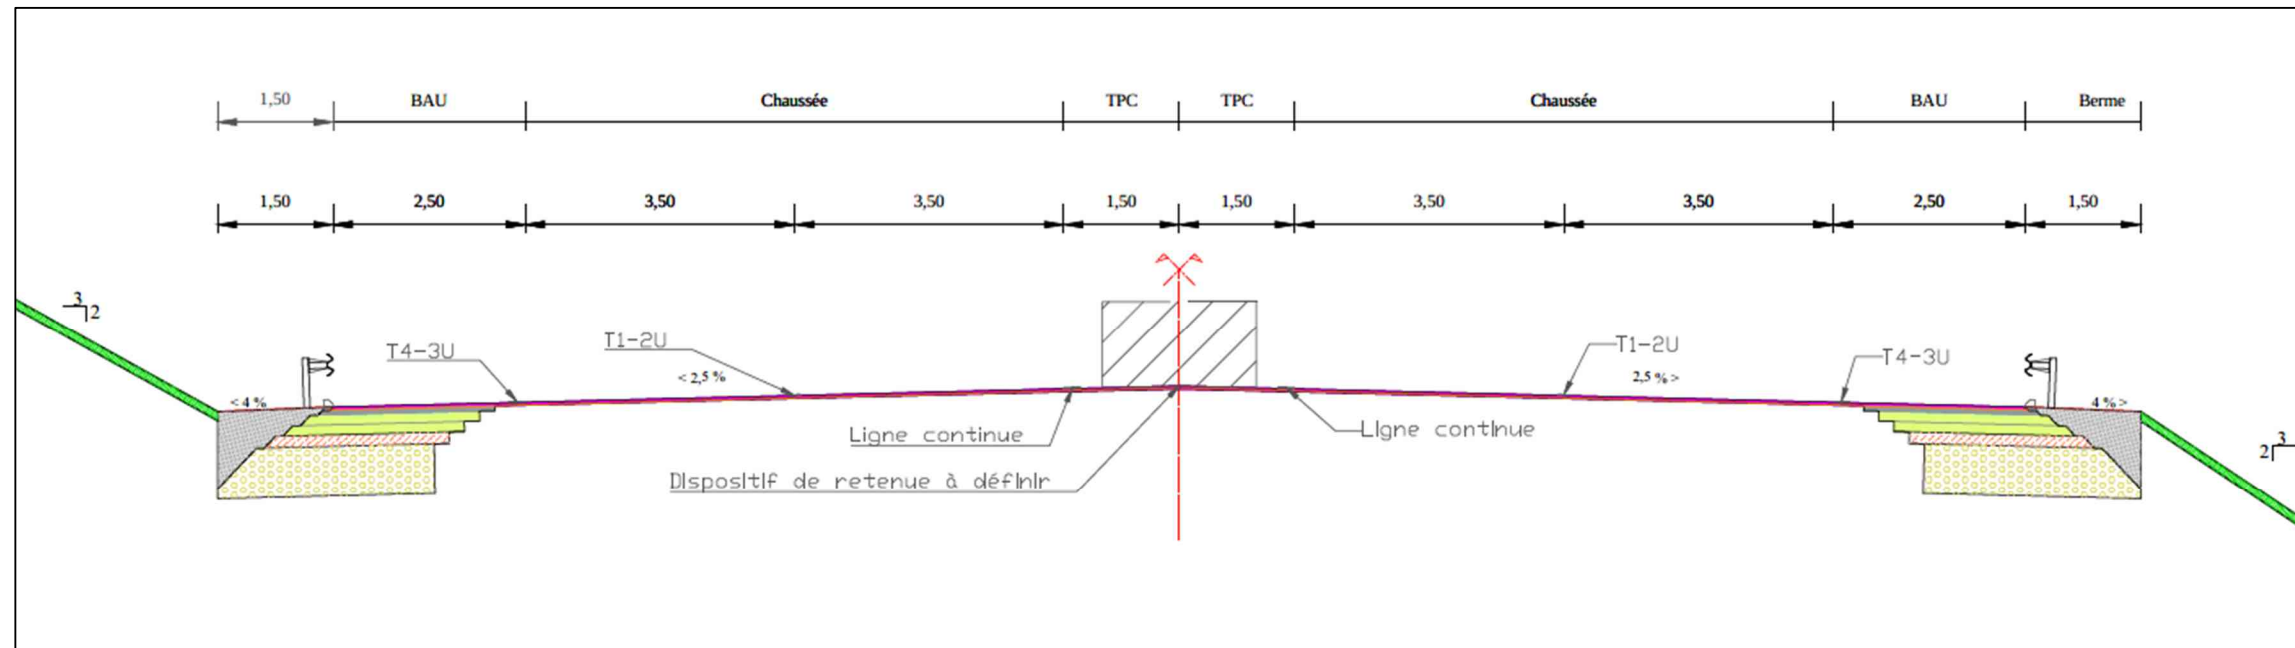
Profil en travers type – Bretelle Vannes/Rennes
